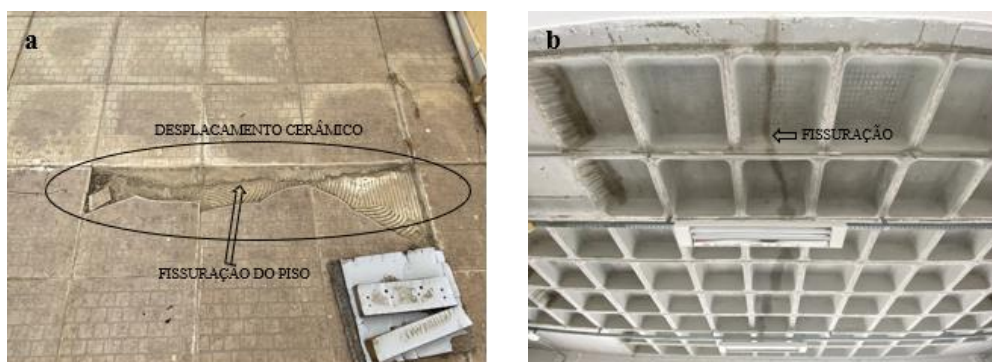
Laje F1 - a) deslocamento cerâmico e fissuração do piso na parte superior da laje; b) fissuração na parte inferior da laje.
